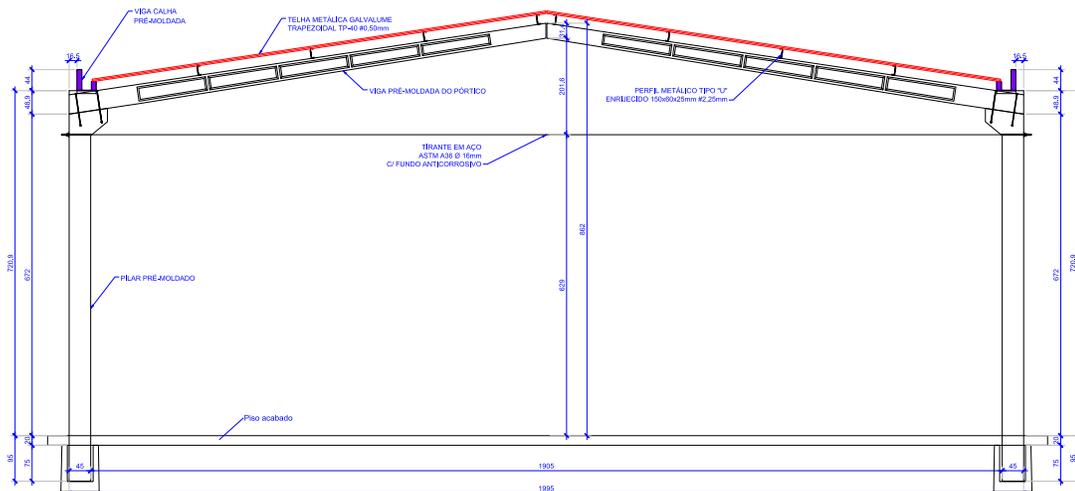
Corte transversal eixos 2, 3 e 4 da obra do caso B
